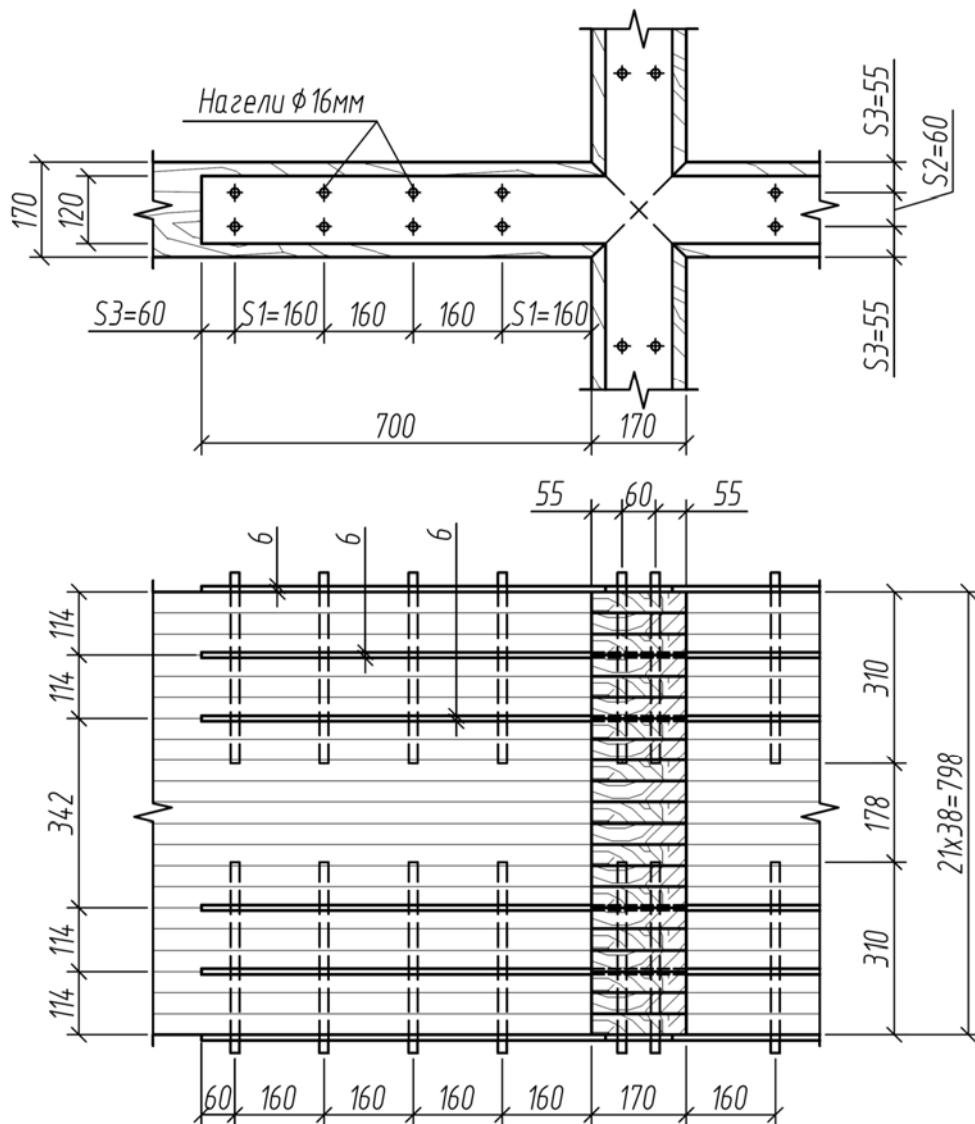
Конструкция узла сопряжения балок по варианту №2 (тип А)
